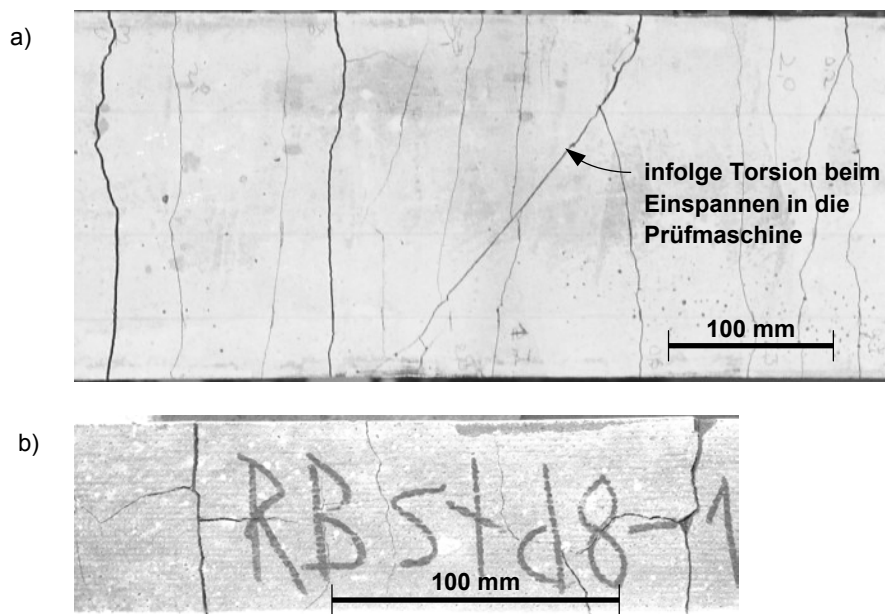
Rissbild des ausschließlich betonstahlbewehrten UHPC-Zugkörpers (a) und Längsrissbildung an der Schmalseite in der Achse der Stabbewehrung (b), aufgenommen nach Erreichen der Streckgrenze der Bewehrung
